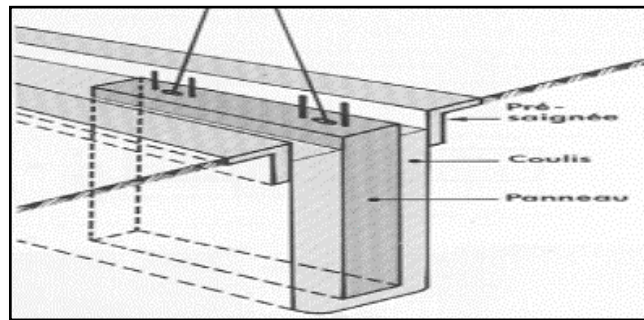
Principe de construction d'une paroi moulée préfabriquée. [46]
